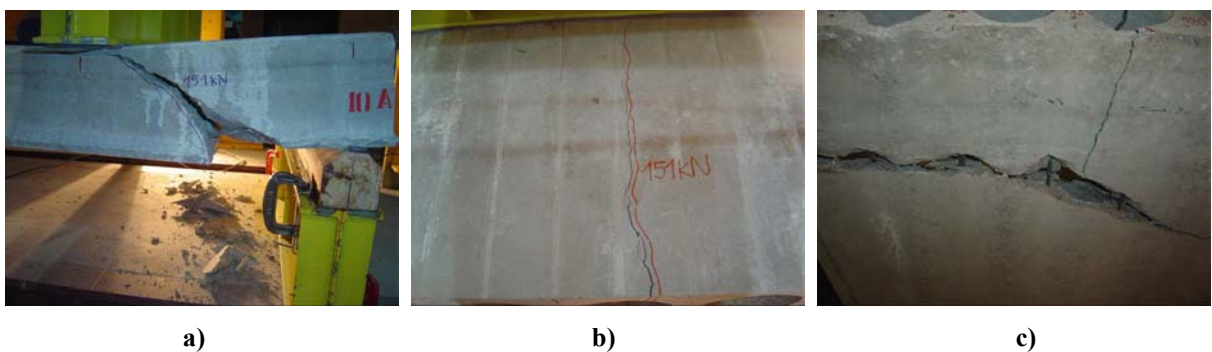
Abertura de fissura da laje L10-20-SC-7_C: a) Vista lateral - lado esquerdo; b) Vista Superior da laje, fissura longitudinal; c) Vista inferior da laje.
